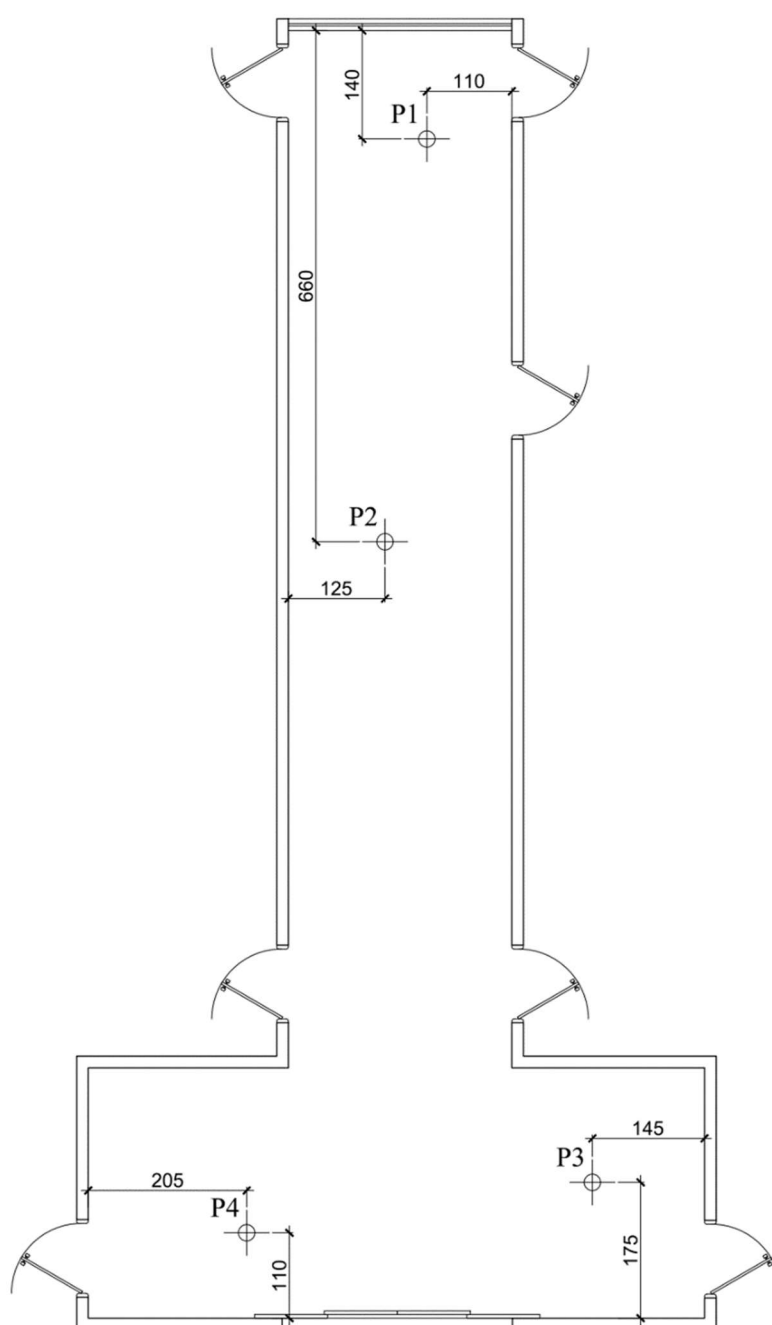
Locação de pontos – LAeq – Corredor do Pavimento Superior
